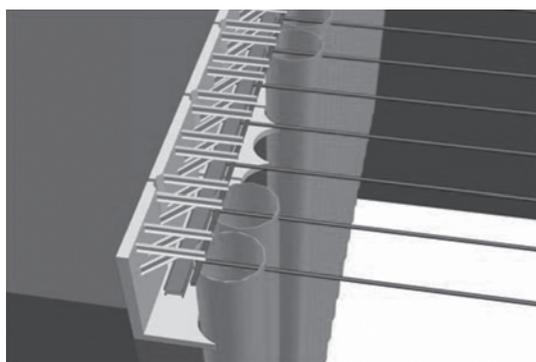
岸壁コーピング、プレキャスト型枠施工イメージ図
